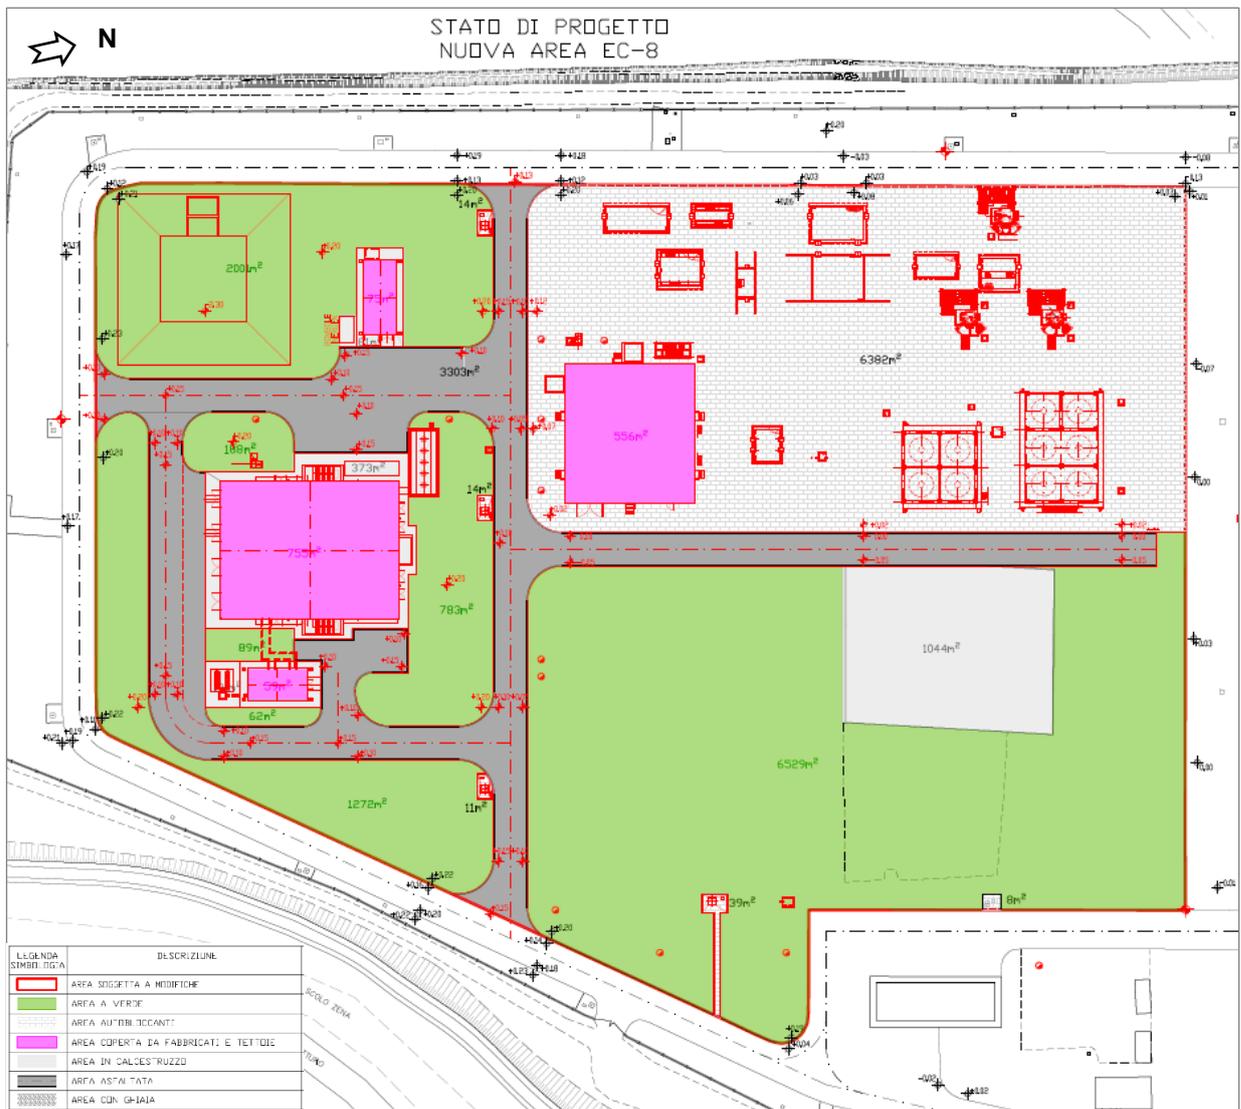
Stralcio di planimetria generale opere civili stato di progetto, in colore rosso (Rif. [3])
